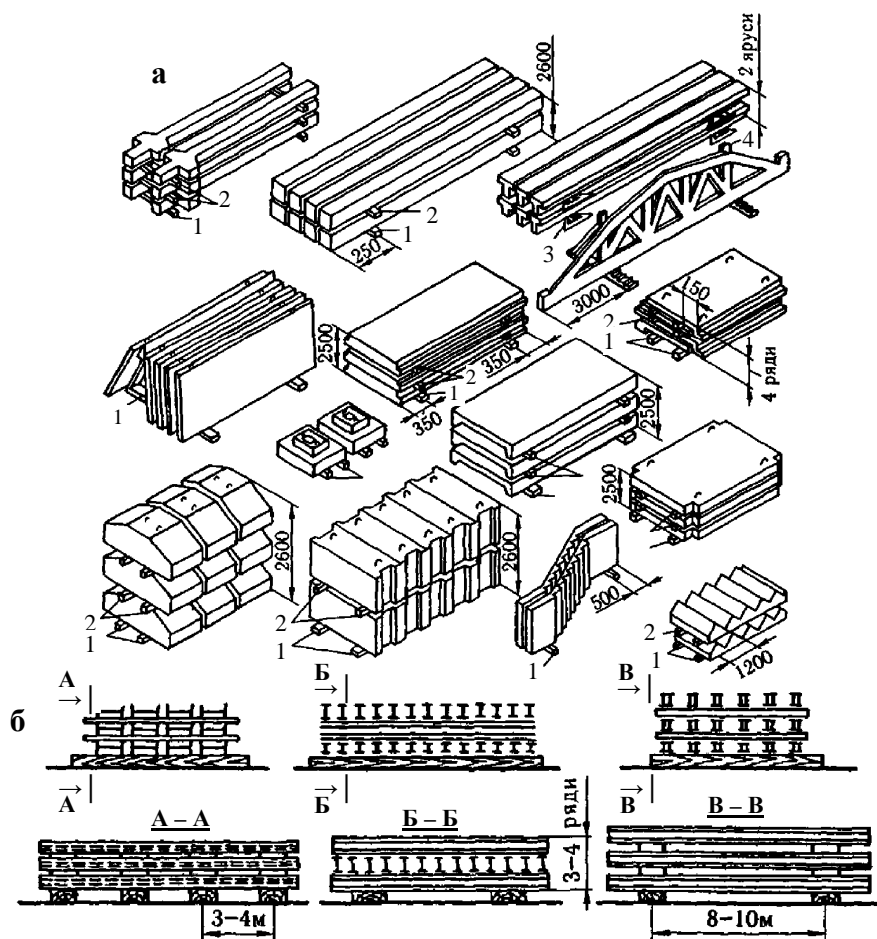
Складування будівельних конструкцій: а – залізобетонних; б – металевих; 1 – лежні-підкладки; 2 – прокладки; 3 – металеві опори; 4 – касета
